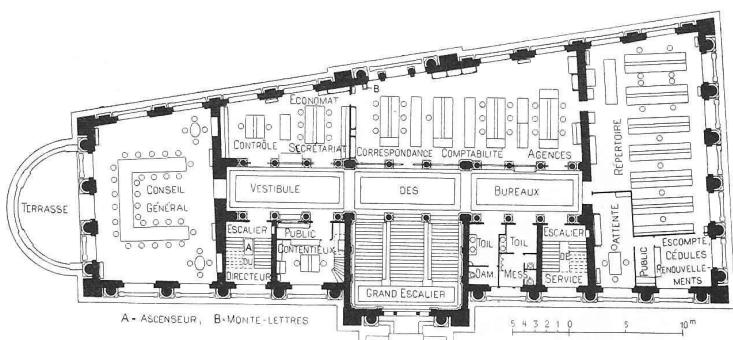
Plan du premier étage. — Echelle 1 : 600.
